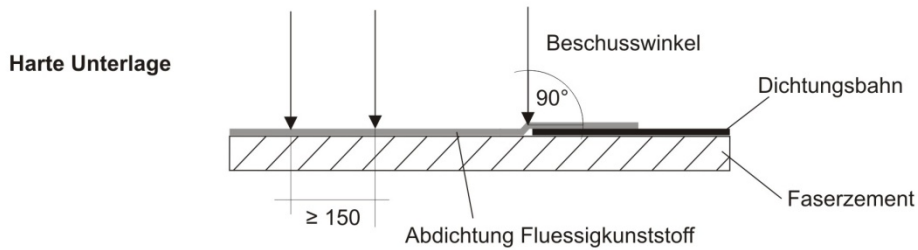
Beschussorte Kante und Fläche beim Probekörper Flachdach
